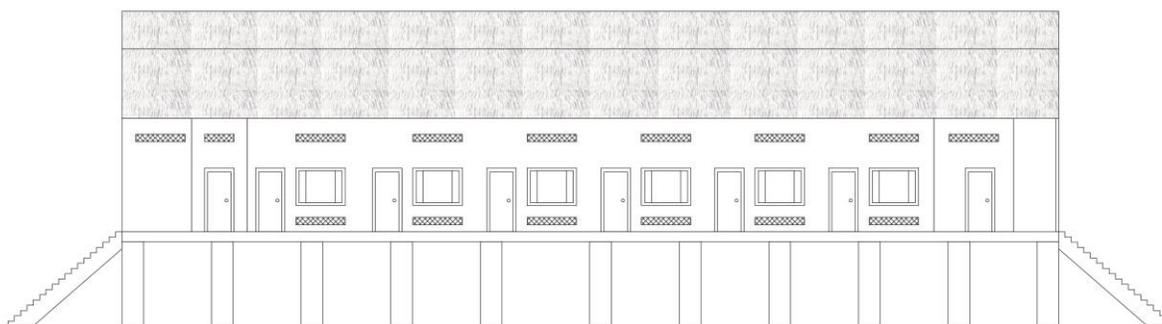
Fachada lateral de la posada/Fuente: Elaboración propia
